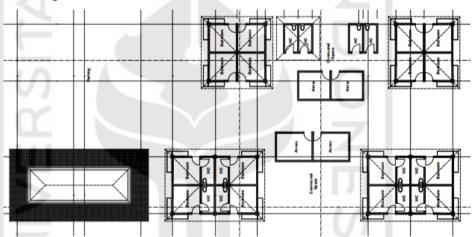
Alternative Skematik Denah Lantai 1
